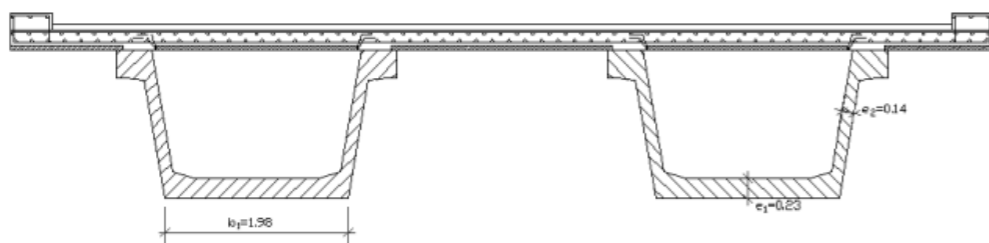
Tipología de Tablero alternativo con vigas artesa en alternativa a vigas en doble T.
